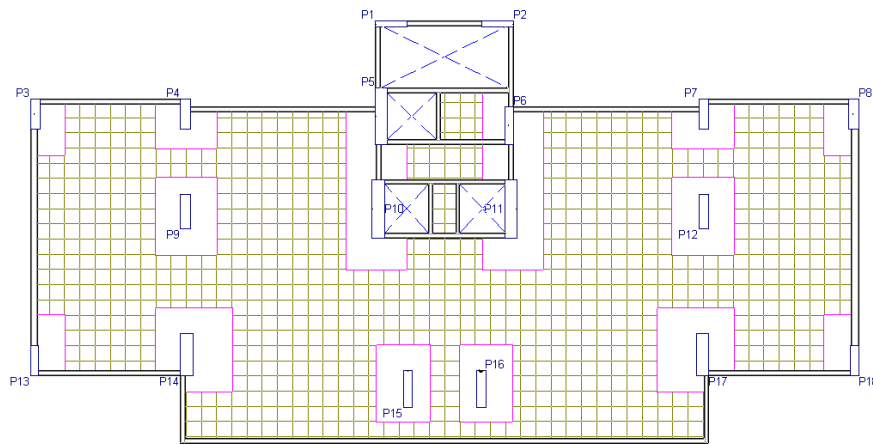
Planta de fôrma do edifício modelo (AUTORES (2020))
